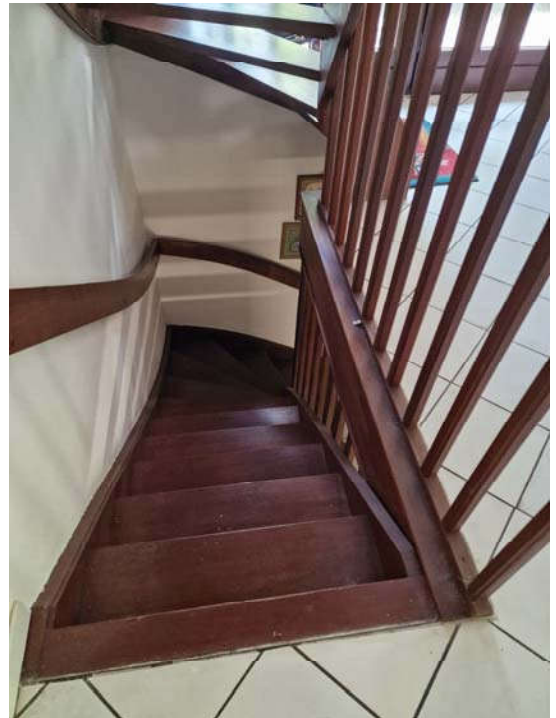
Separater Austritt für Gäste-Zimmer im Kellergeschoss mit Niedergang (ehemals Garage)
